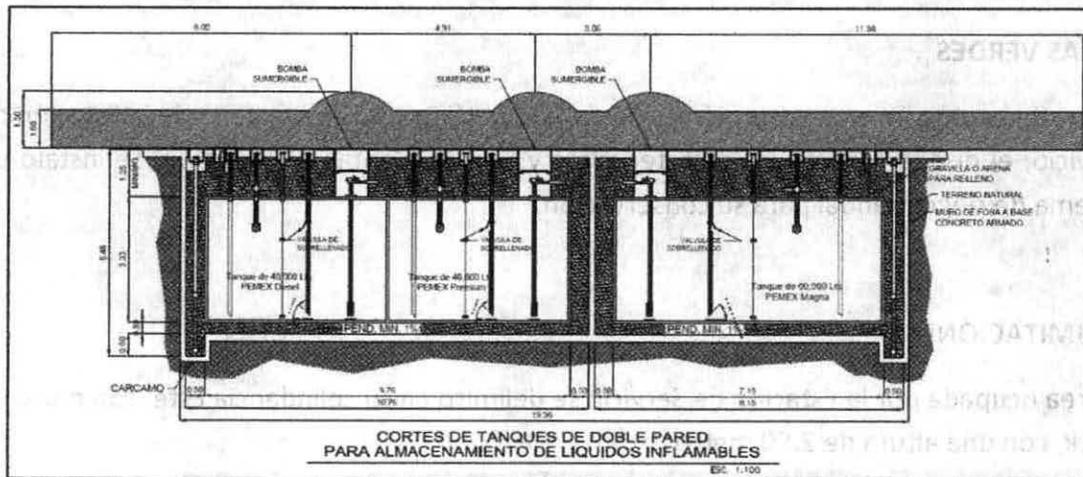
Detalle del Sistema de Almacenamiento de Líquidos Inflamables instalado.
